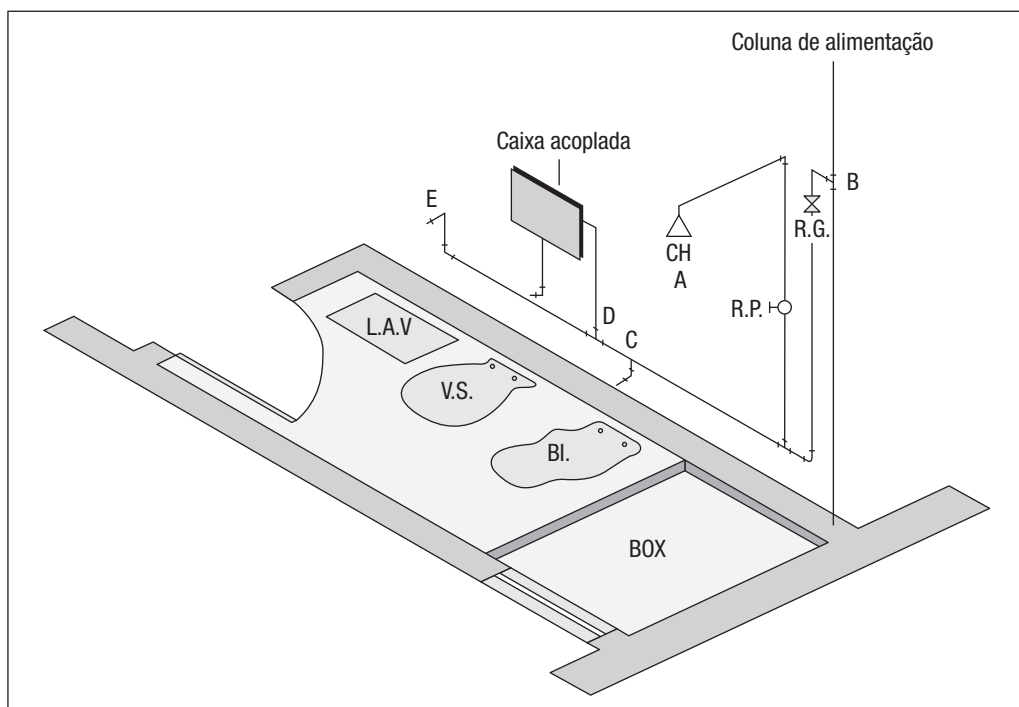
Planta de sanitário com isométrico aplicado.
